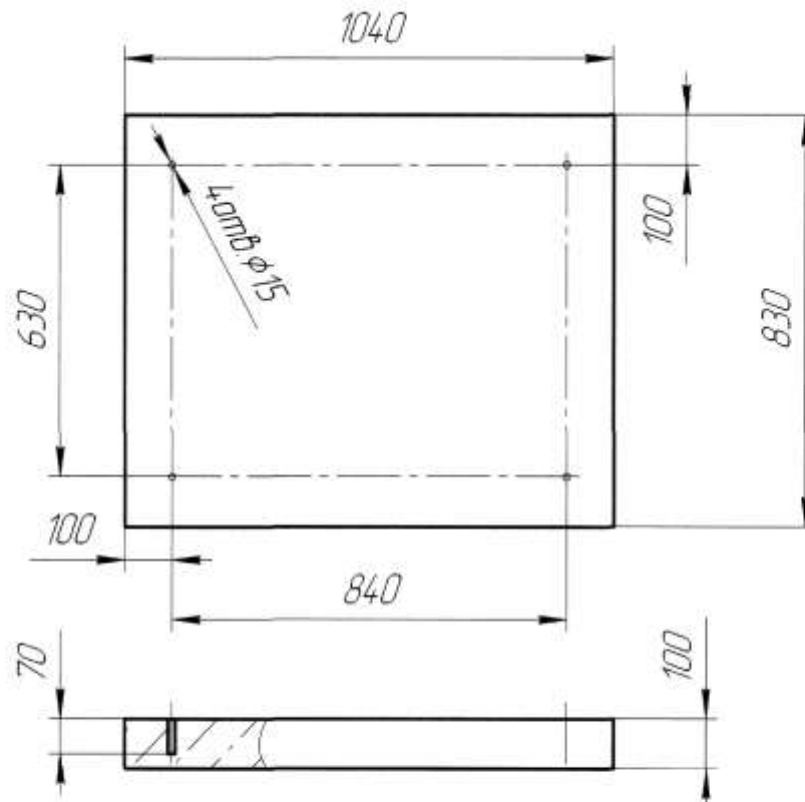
Окончательная схема фундаментной площадки волчка К6-ФВП-1200
